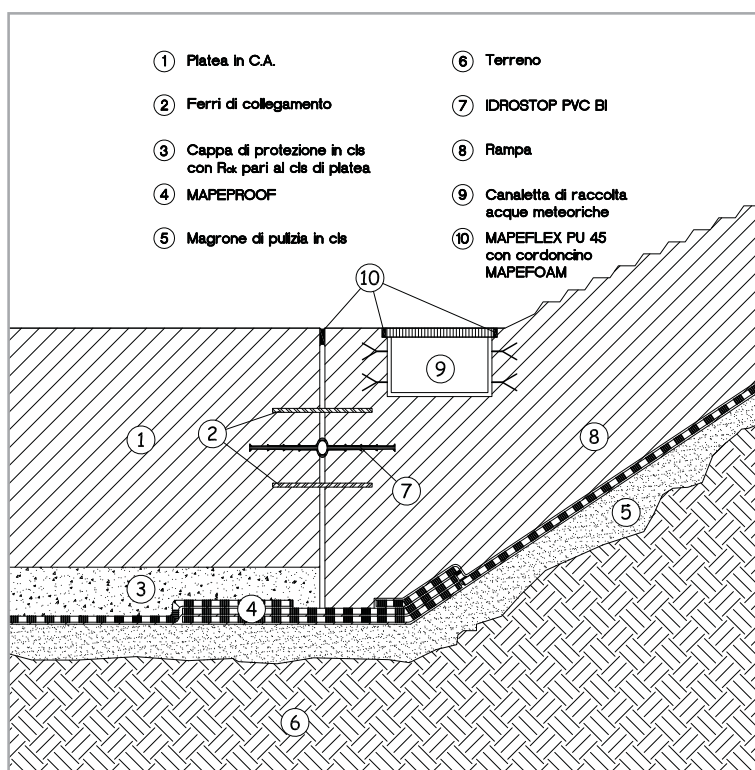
Particolare tecnico dell'impermeabilizzazione di una rampa, di accesso ai garage sotterranei, strutturalmente indipendente dal resto del fabbricato
